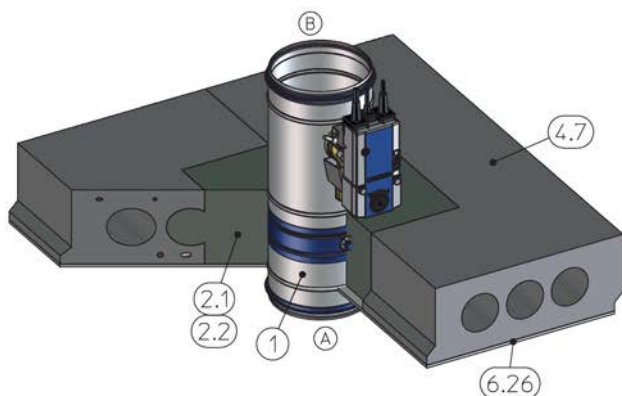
Installazione a base di malta in soffitti a pietra cava, raffigurata verticale (applicabile anche per una disposizione sospesa)
